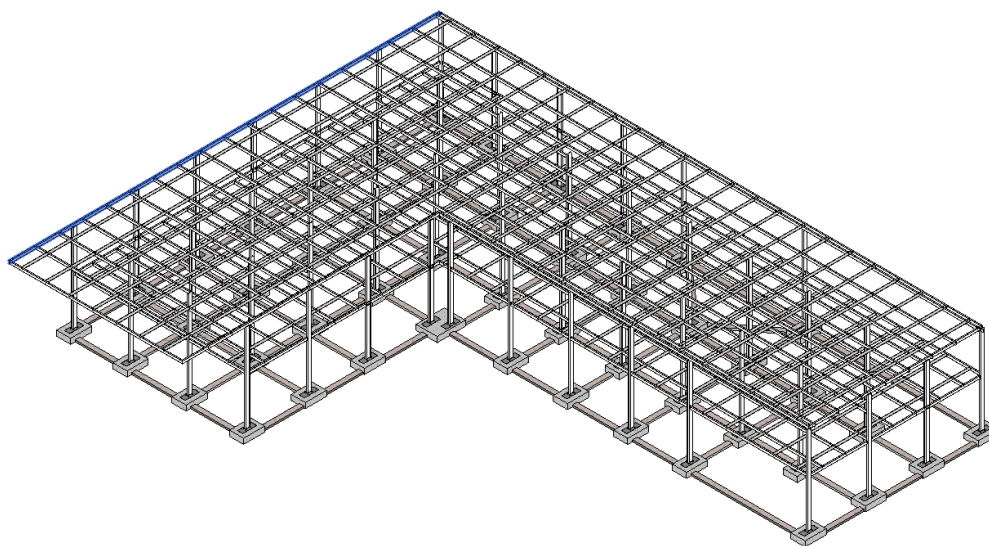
Modelo estructural completo en 3D [Elaboración propia]
